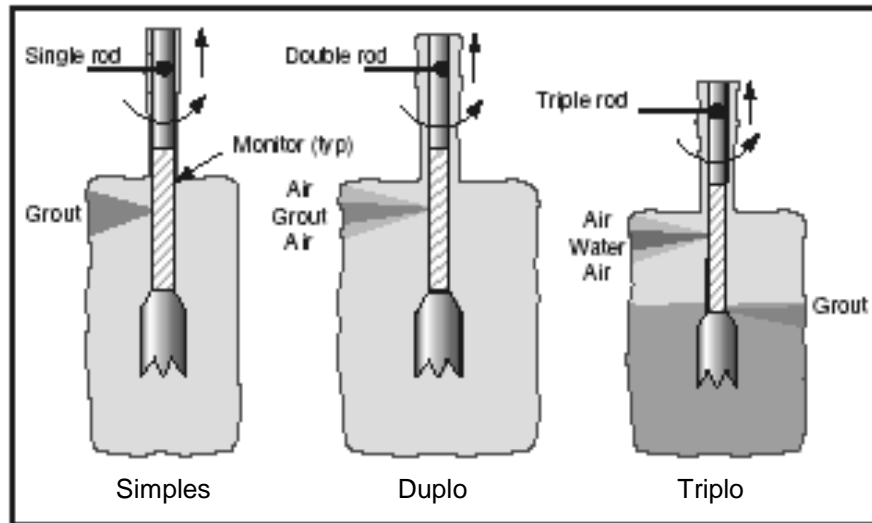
Croqui com a ilustração dos três tipos de hastas existentes no mercado para construção das colunas de “Jet Grouting” – (Fonte: HUSSIN, 2006)
